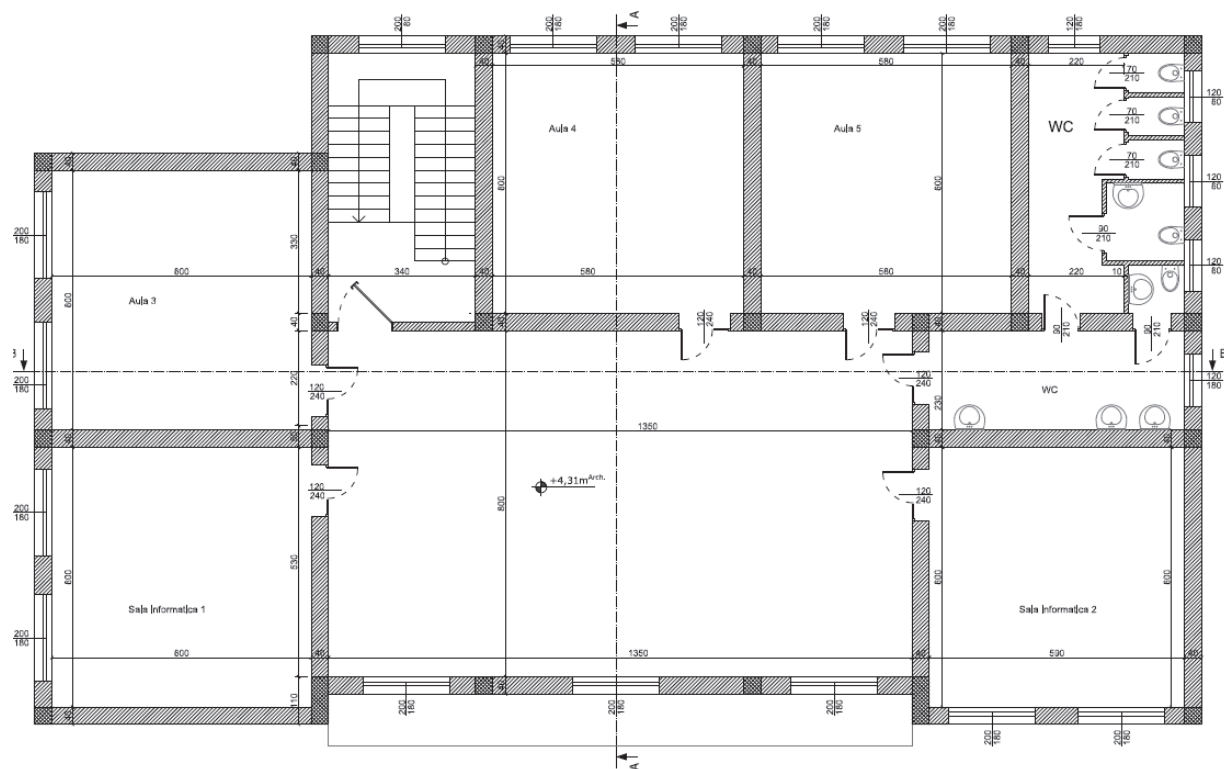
Pianta Piano Primo dell'Edificio
